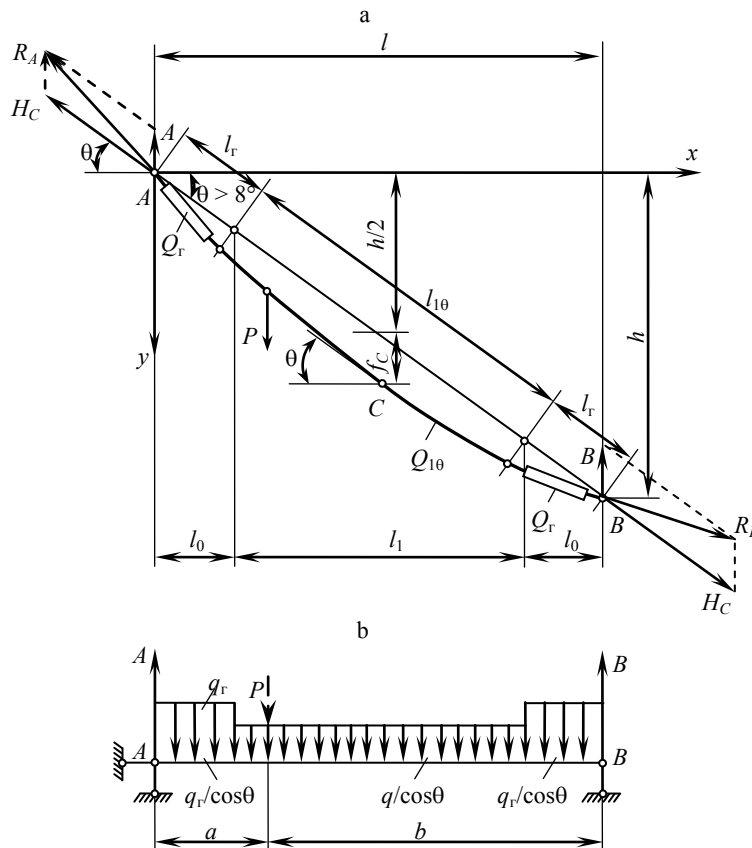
Расчетная схема пролета с разными высотами подвеса проводов: а – пролет с вертикальными нагрузками от провода q , гирлянд изоляторов q_r и сосредоточенной силой P ; б – пролет в виде простой разрезной балки с шарнирными опорами, загруженной так же
